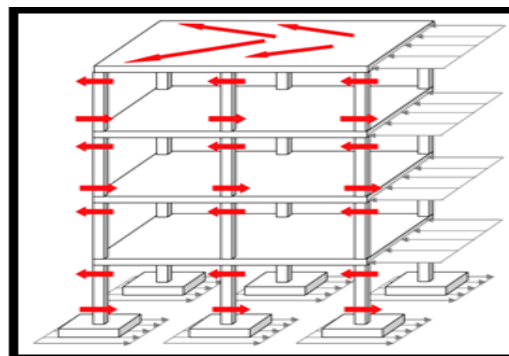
Sistema estructural bajo la acción de acciones horizontales.
